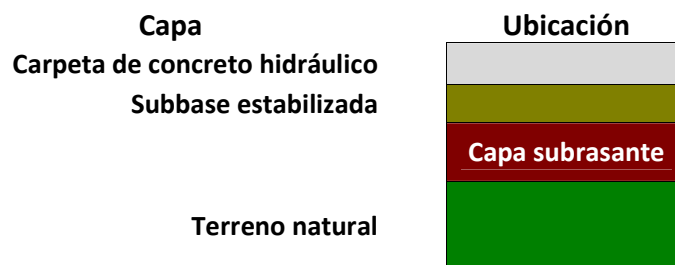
Ubicación de la capa subrasante dentro de la estructura del nuevo pavimento.
